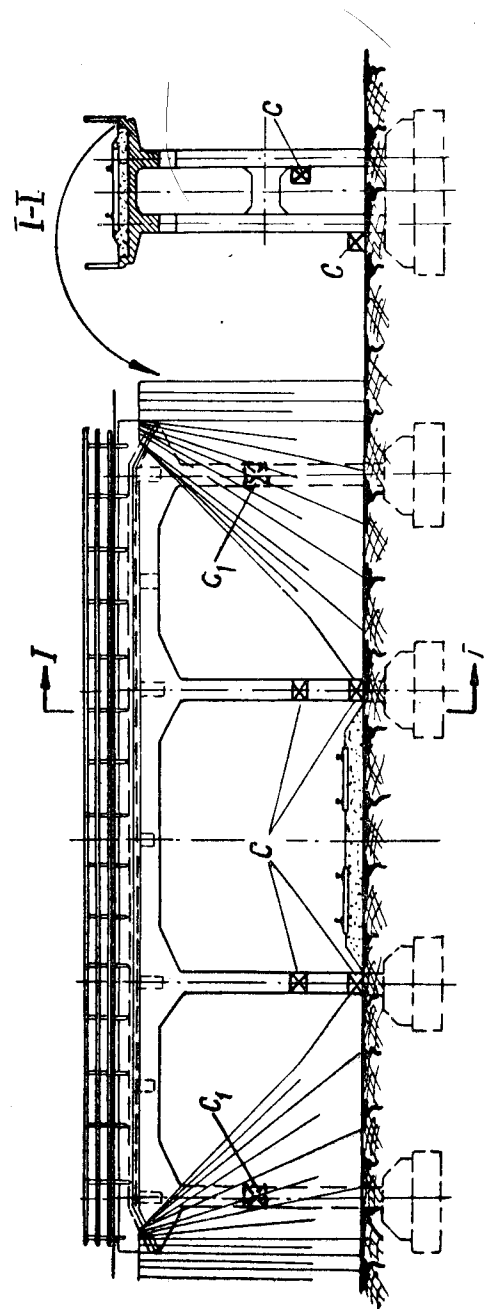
Расположение зарядов при разрушении железобетонного путепровода
